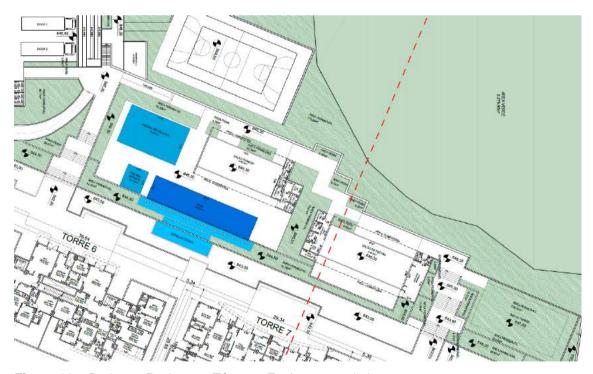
Projeto - Pavimento Térreo - Equipamento de lazer.
